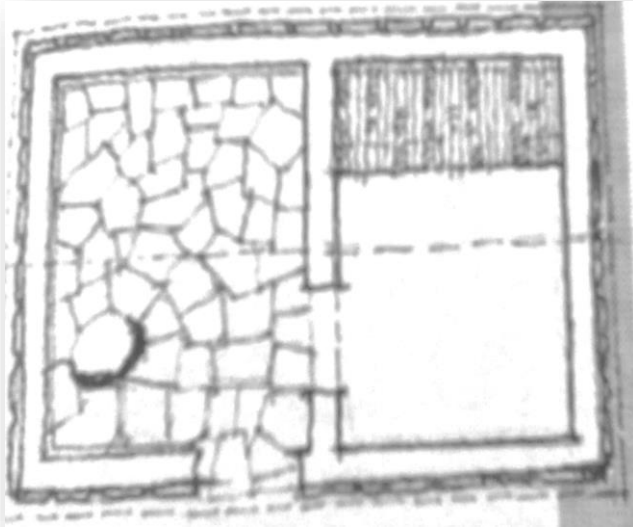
Planta Arquitectónica de Vivienda Neolítica.
